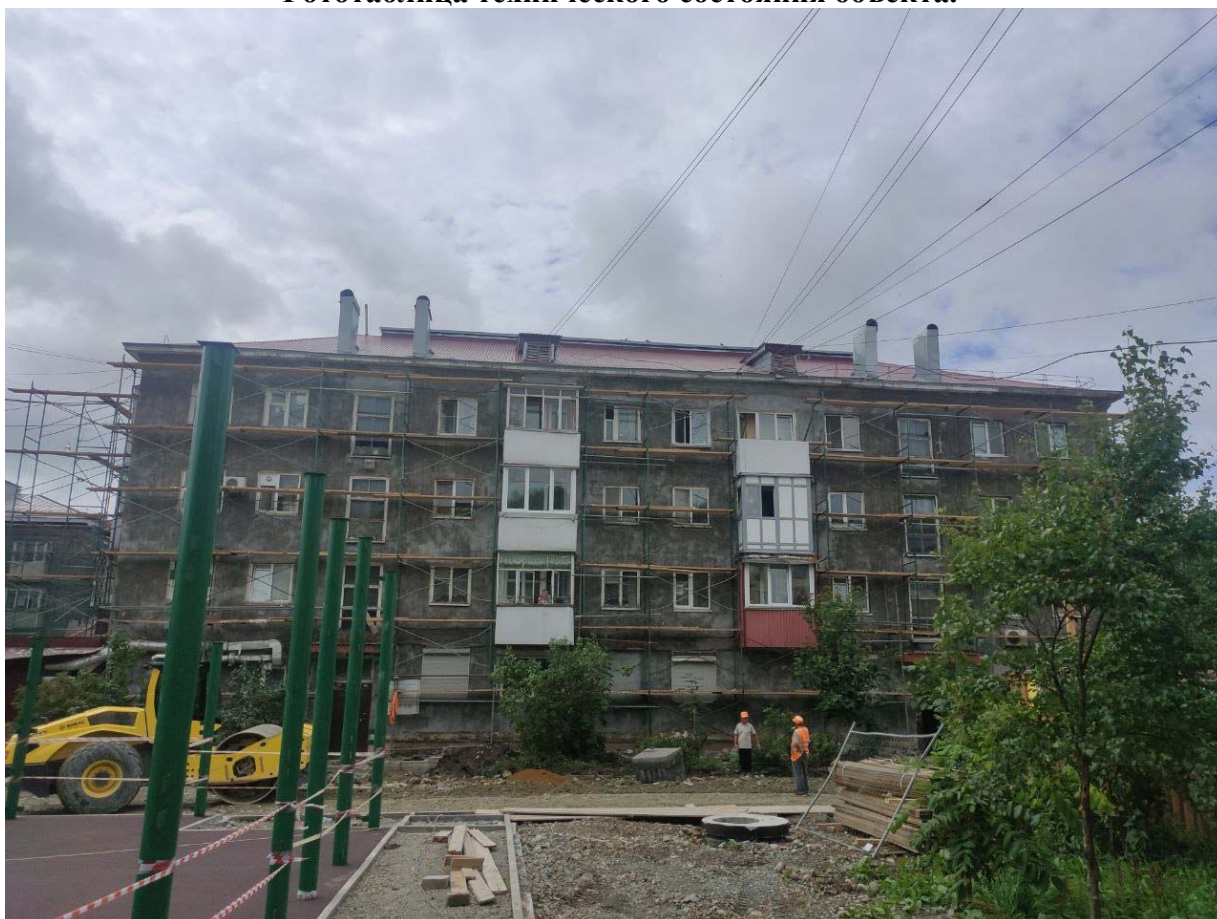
Проводятся работы по капитальному ремонту фасада здания.
